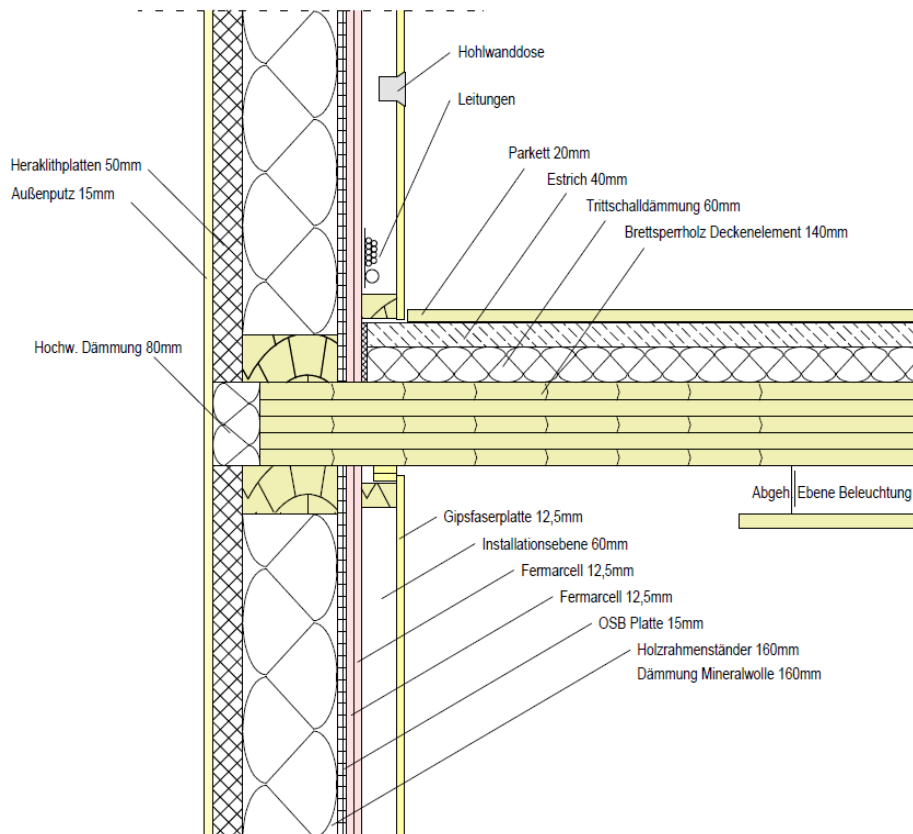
Erdgeschoss, Anschluss Außenwand / Decke
